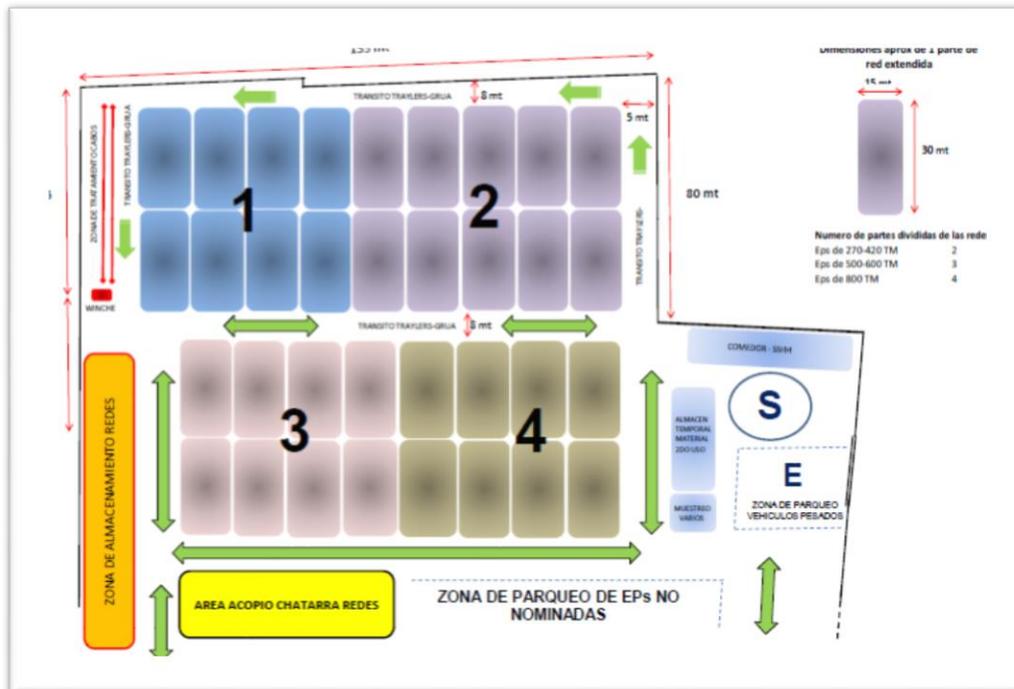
Plano del área uno y dos de propuesta para techado de redes. Fuente: Copeinca Flota
